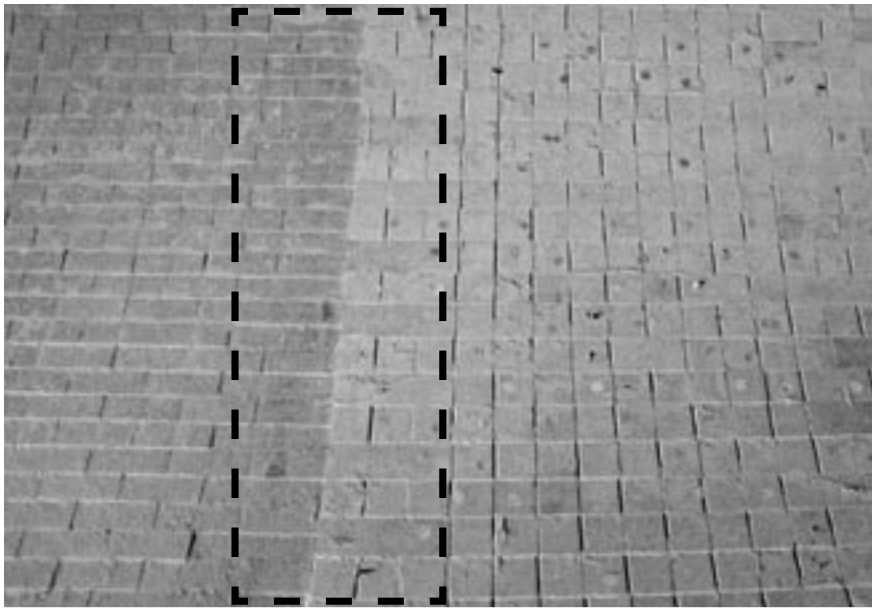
Übergang zweier Blöcke im Verbundmauerwerk
